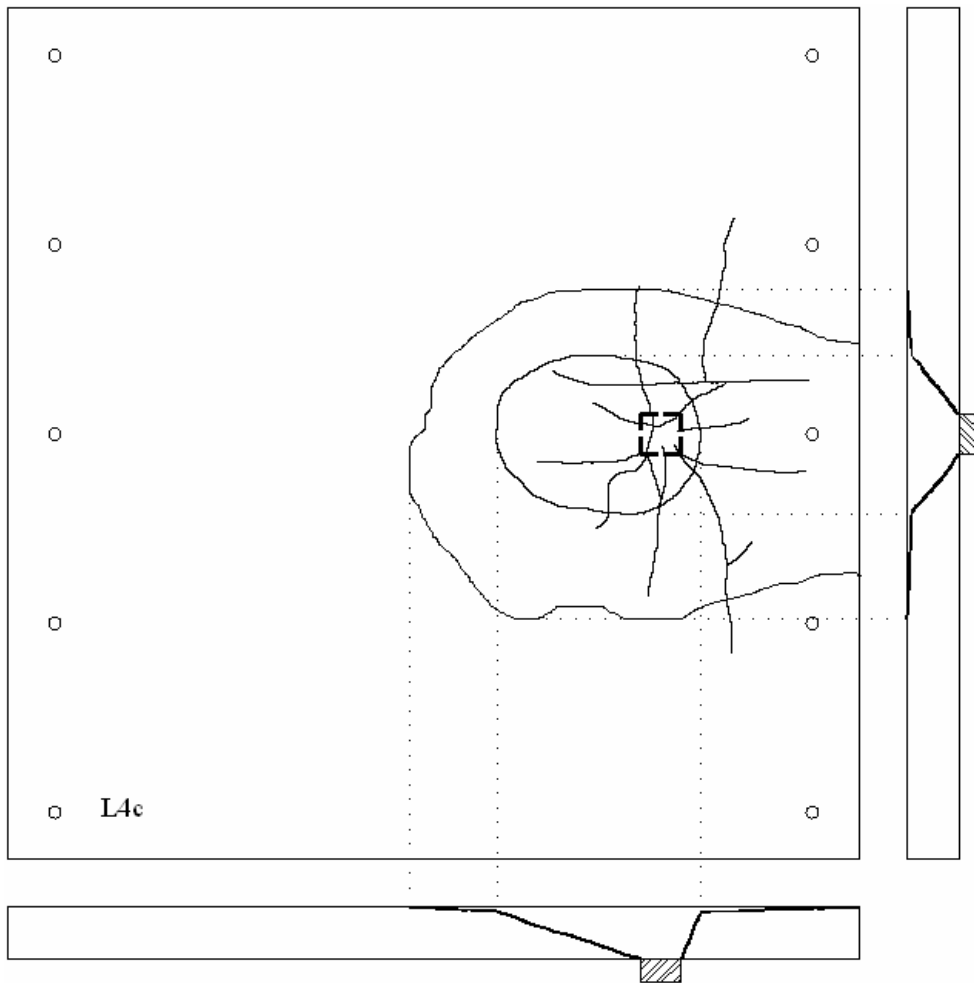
Mapa de fissuração da laje L4c
